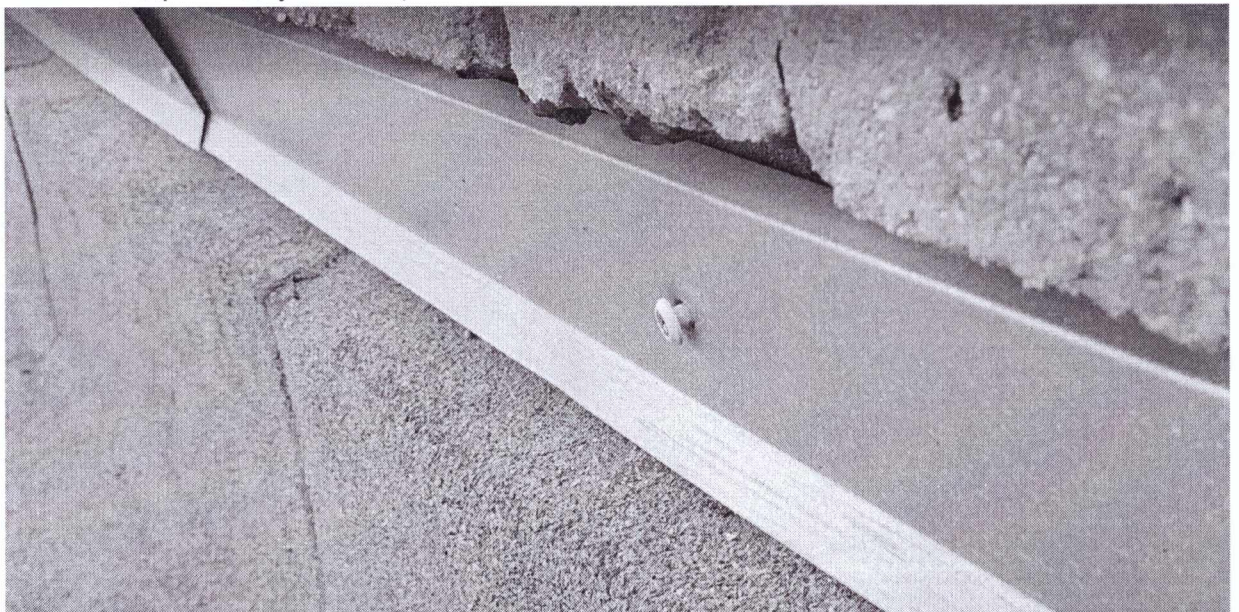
Відсутнє кріплення, не щільне прилягання прижимної планки (кріплення, ударний дюбель не забитий до кінця).
